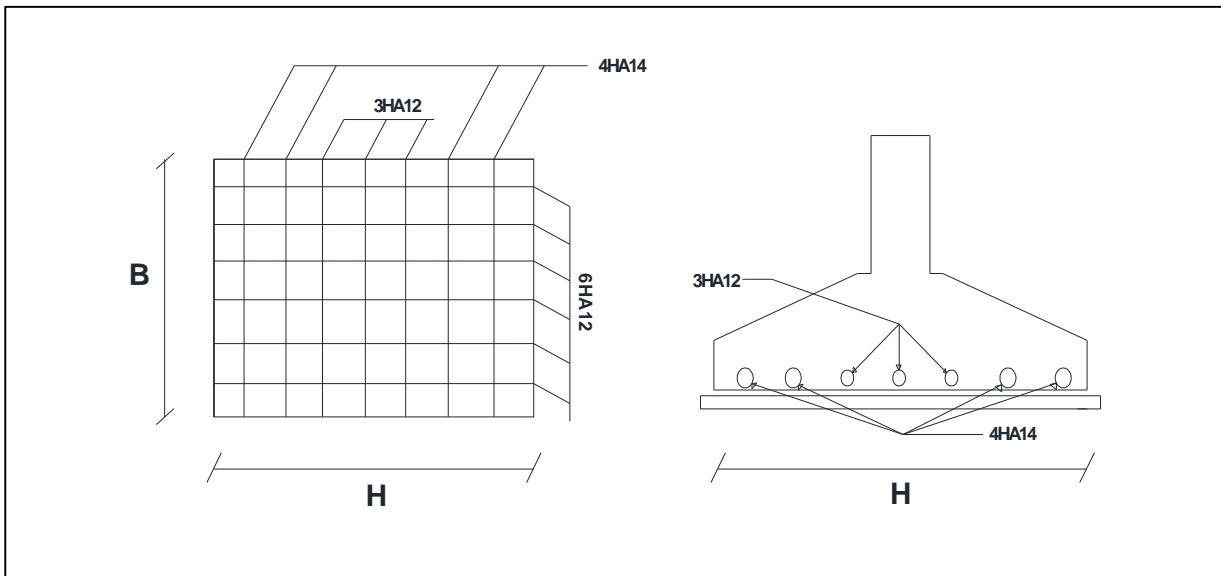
schéma de ferrailage de la semelle au-dessous de poteau.
